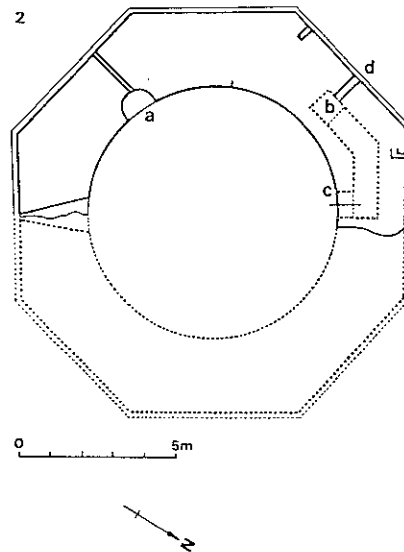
Brustem, plan niveau 2, 1160-71. a: lavabo; b: latrine.
